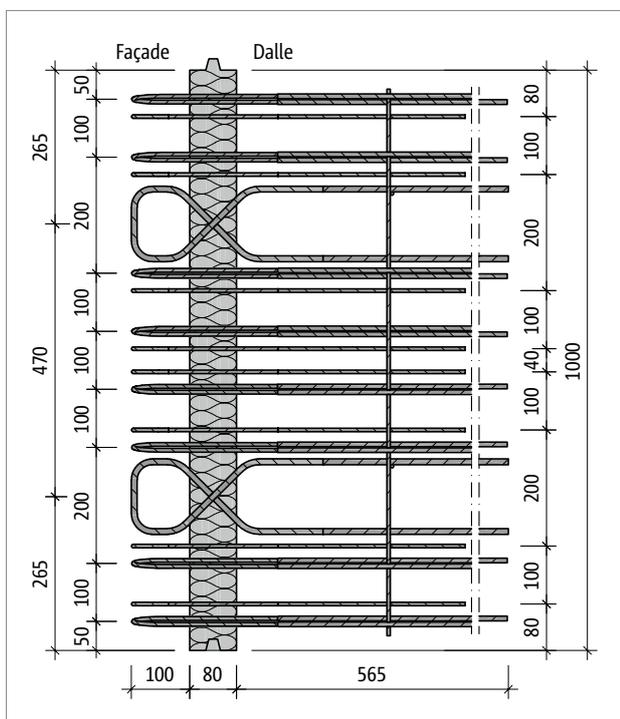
Schöck Rutherma® T type DF-S-V6-LR100 : vue en plan du produit
